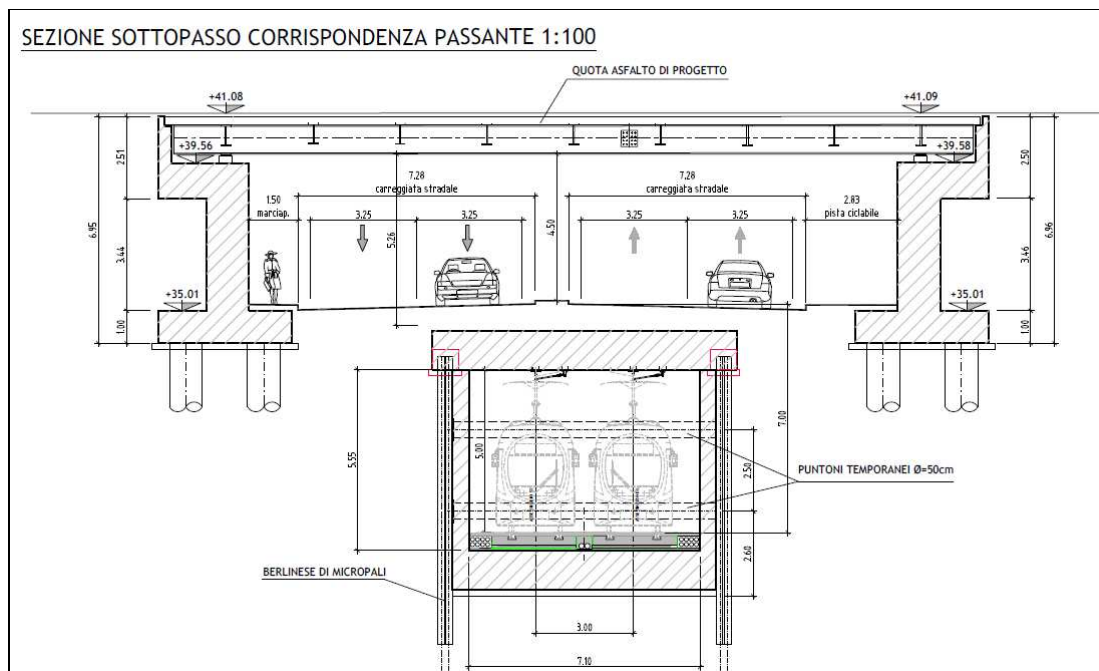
Sezione trasversale sottopasso in corrispondenza del Passante (estratto da elaborato B831-C-SF-STR-RT002A)
